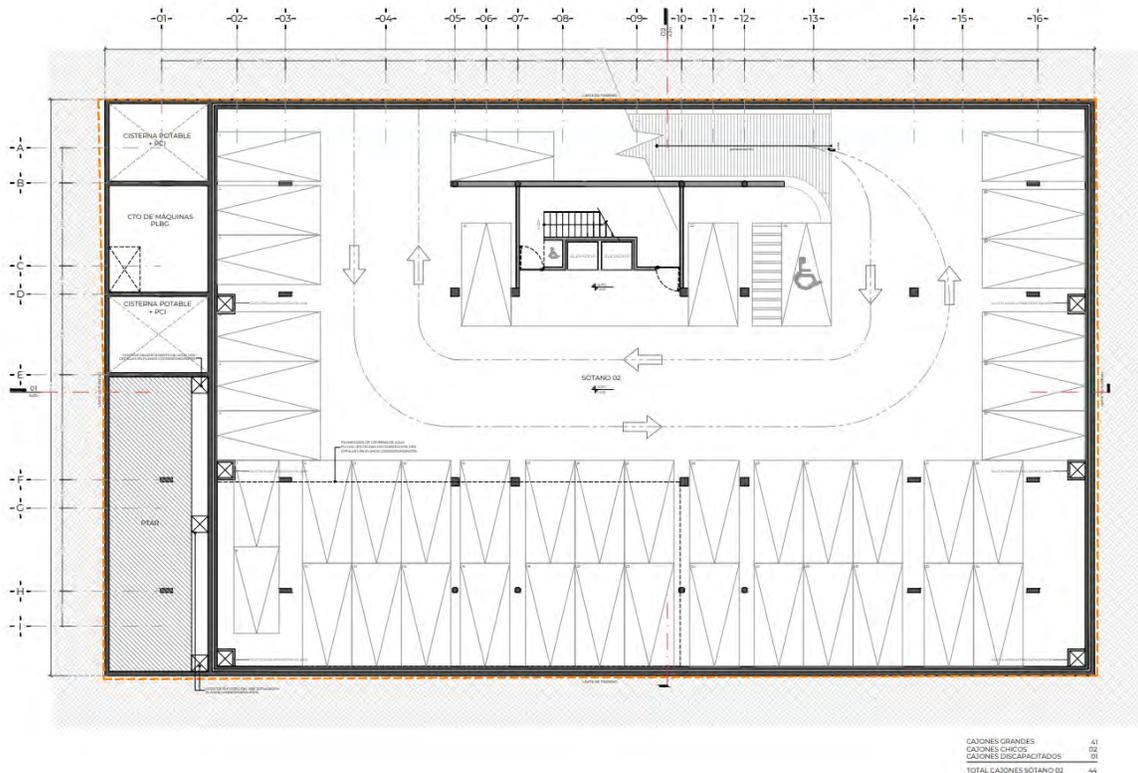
Plano estructural de los sótanos y cajones de estacionamiento (Se anexan planos a detalle).
